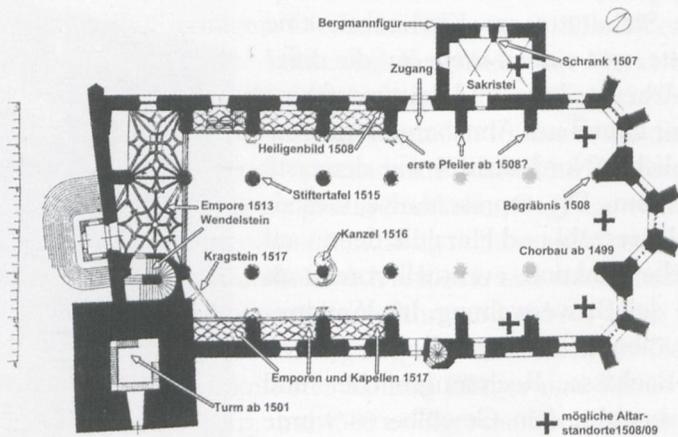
Grundriss der St. Annenkirche in Annaberg-Buchholz.
